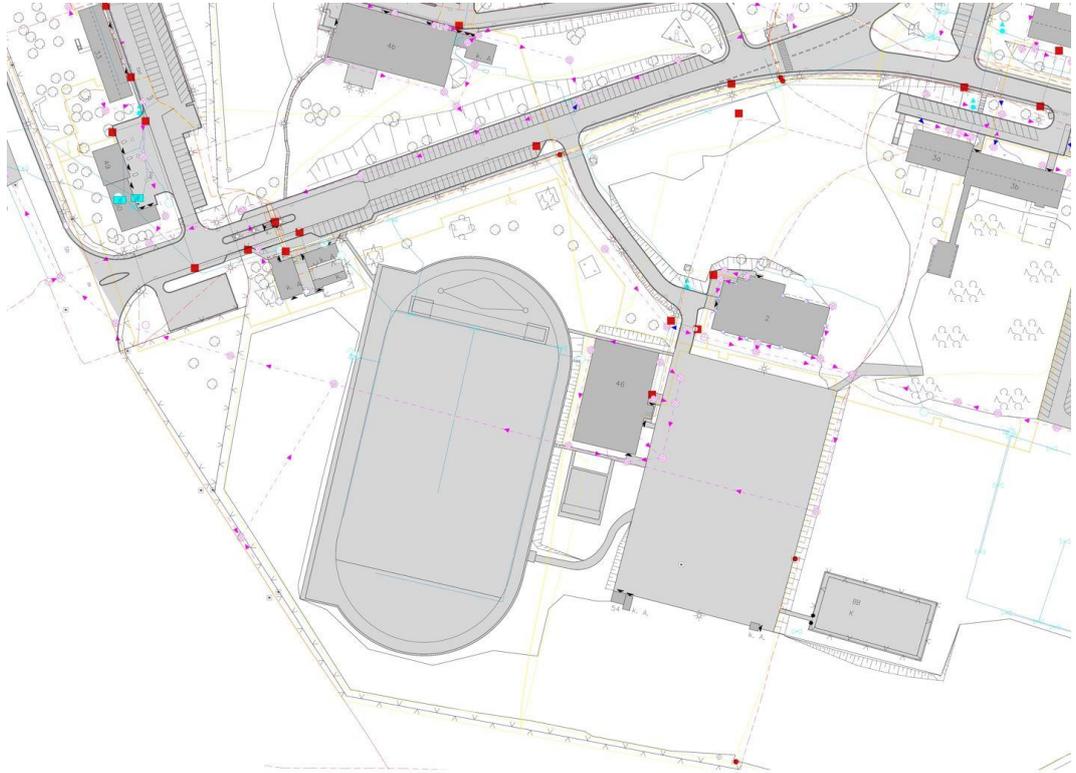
Lageplan Bestand, Ver- und Entsorgung, Quelle: Bundesbau Baden-Württemberg
